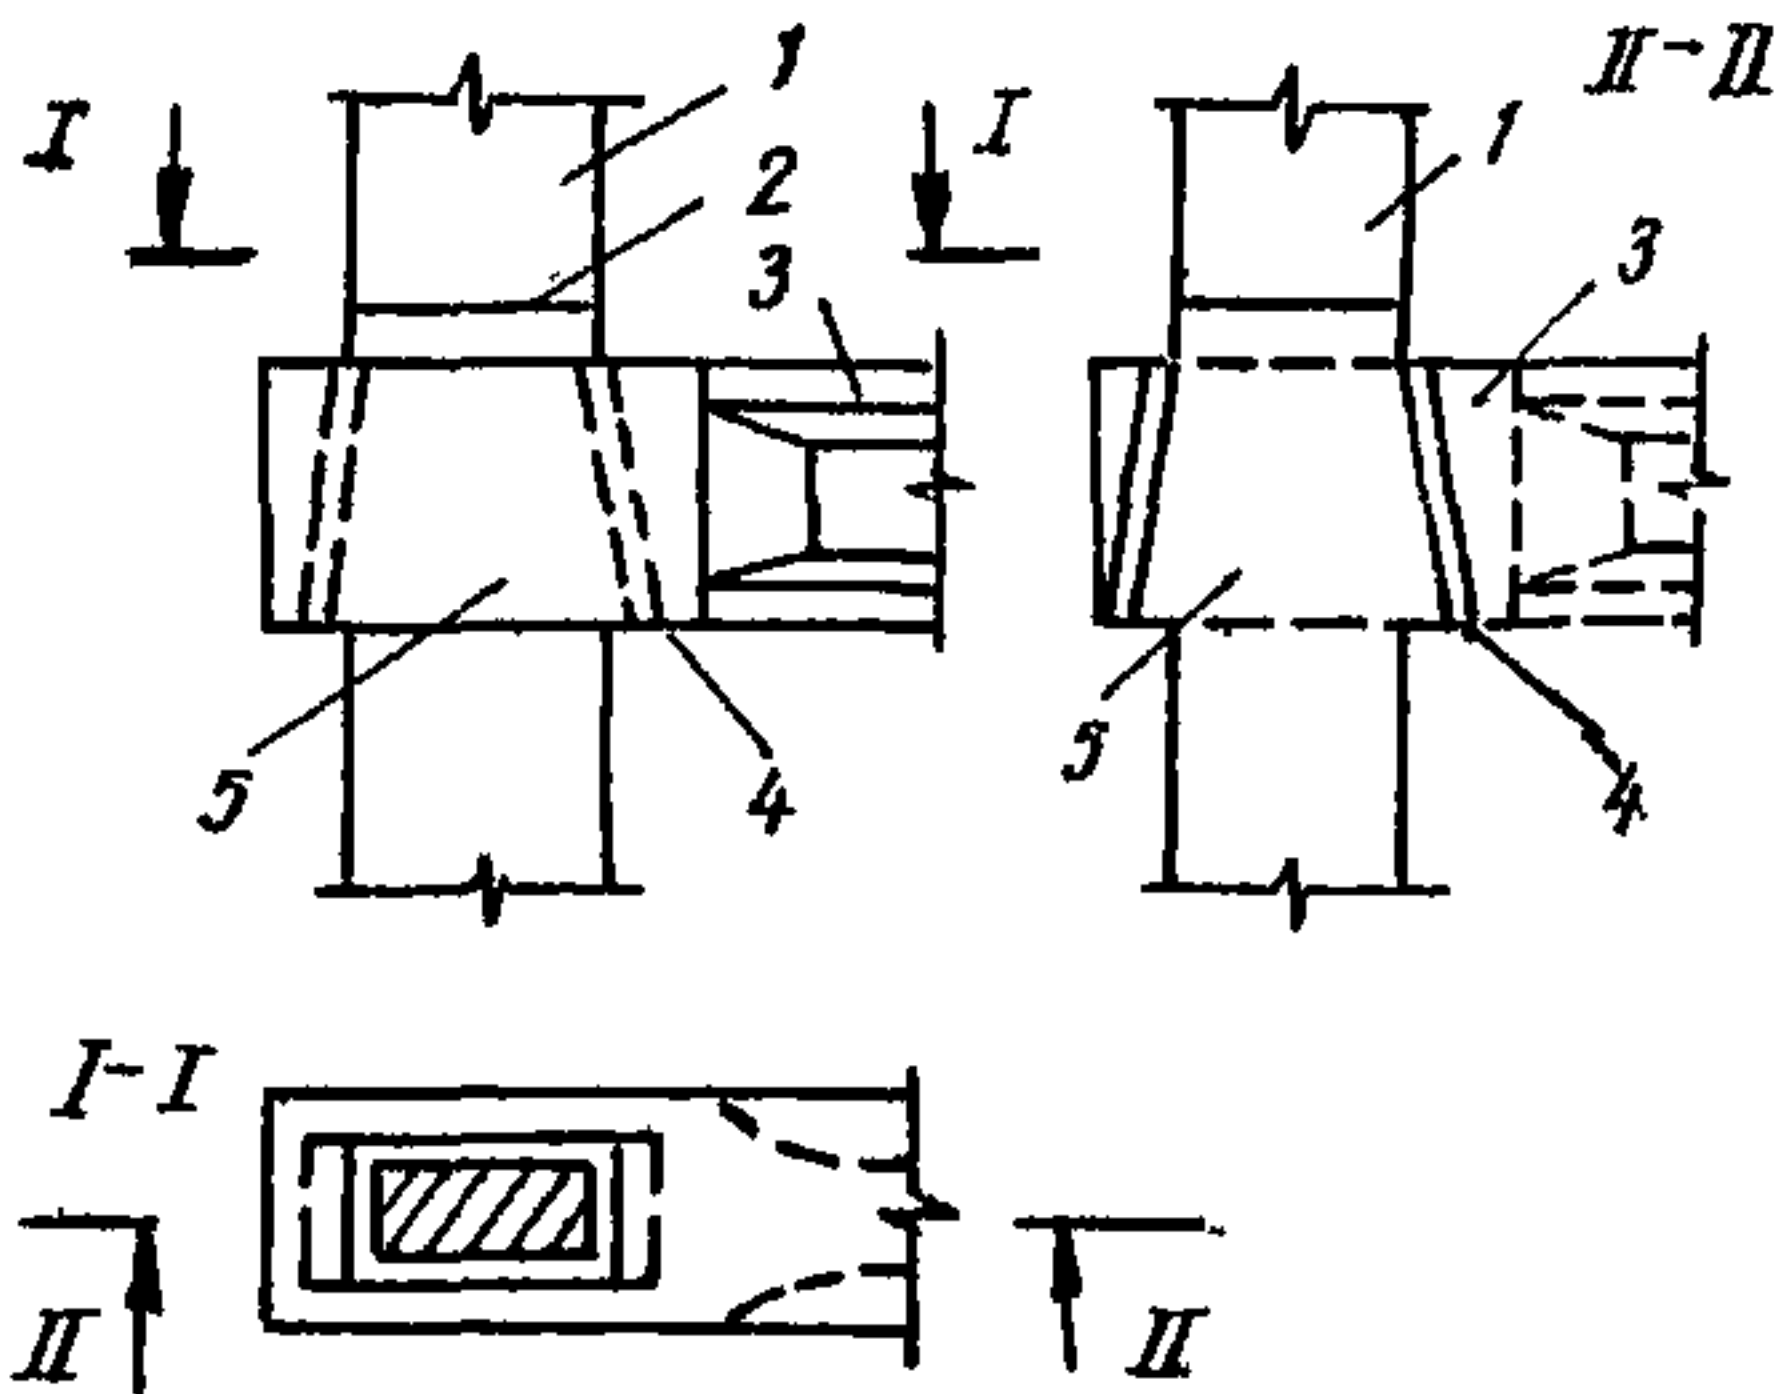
Стык сборных элементов этажерок при ригель-насадках
